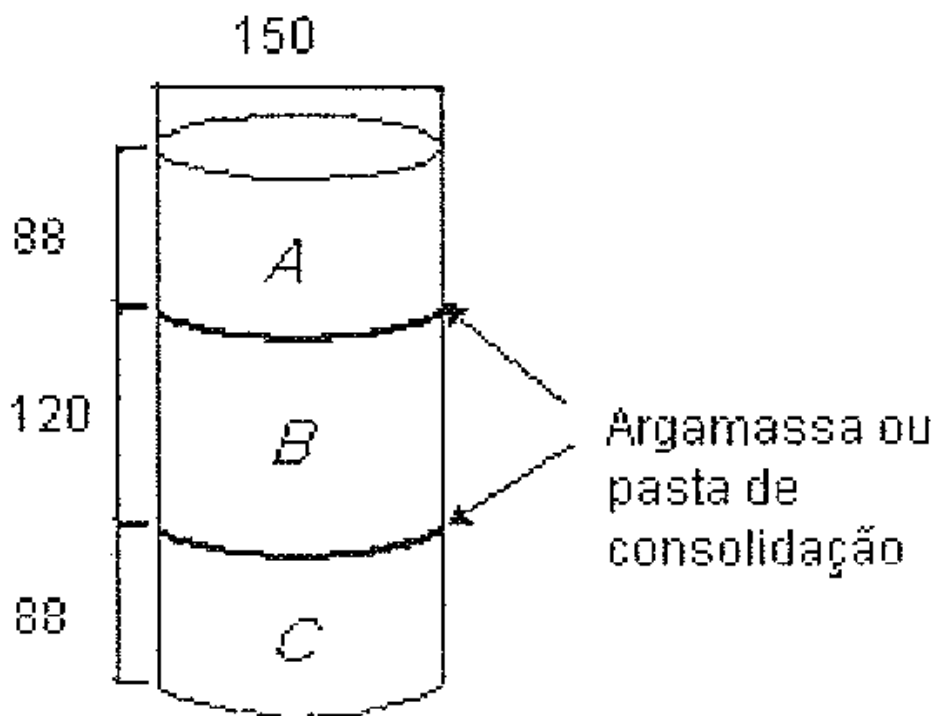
Esquema de montagem de corpo-de-prova tipo I - Dimensões em milímetros
